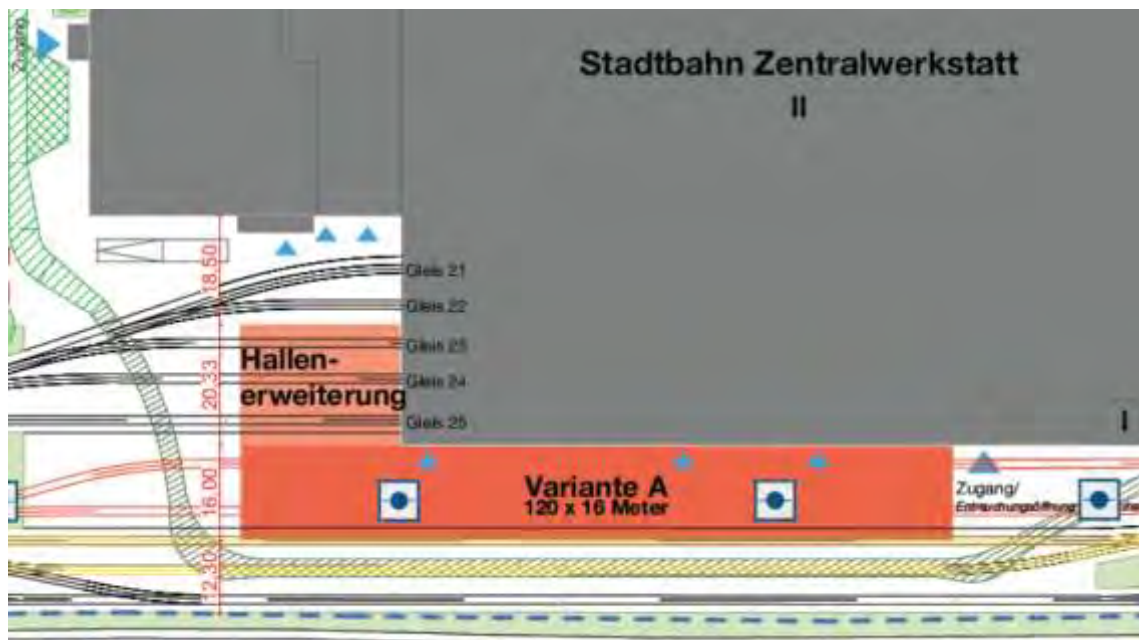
Lage der geplanten Erweiterungsbauten (rot)
